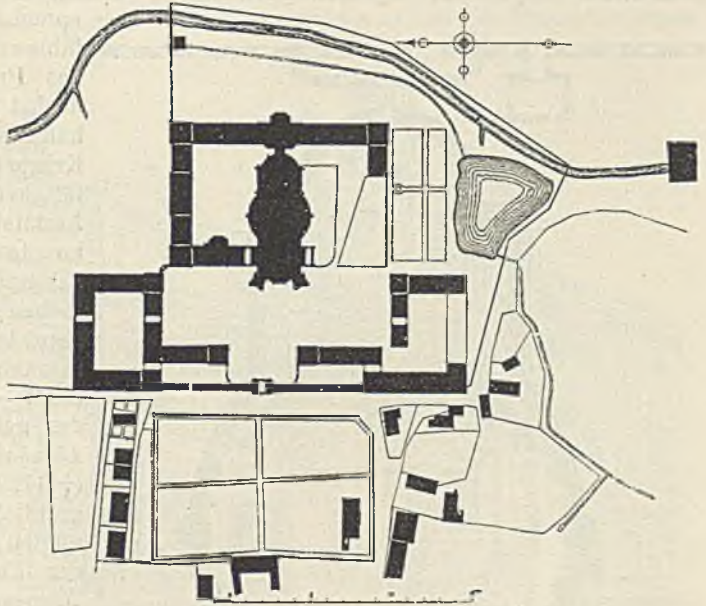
Lageplan des Klosters Wiblingen bei Ulm
